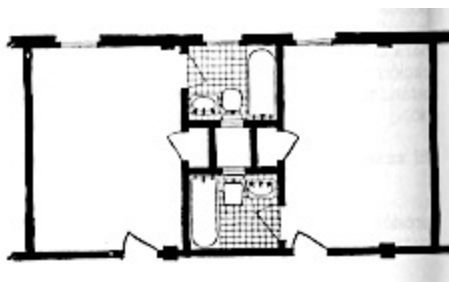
Esquema de las alcobas con baño privado – Hotel Statler - Buffalo 1908
